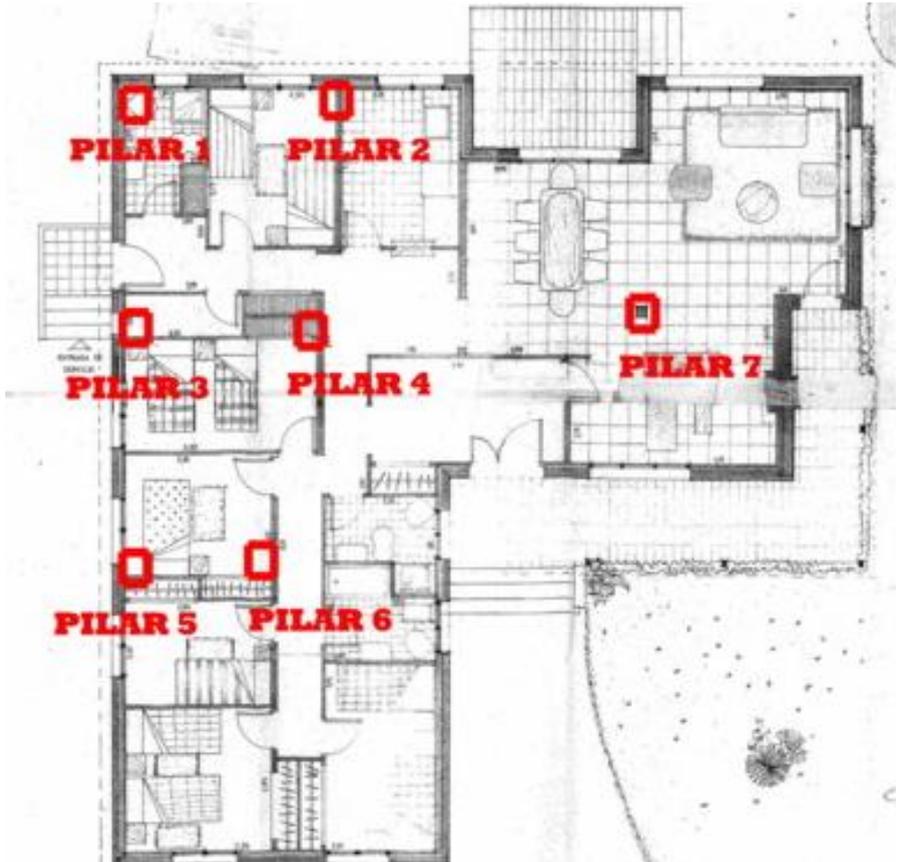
Planta de nuevos pilares. Año 2012. Fuente: elaboración propia.
